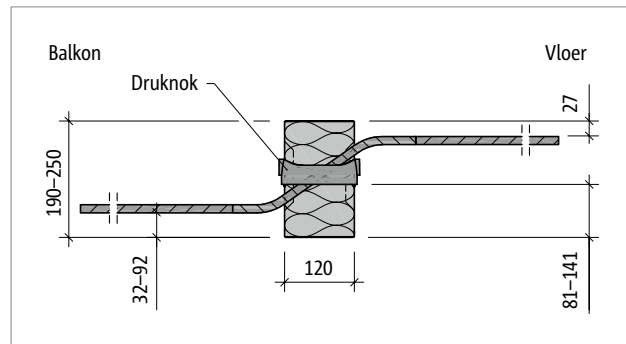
Schöck Isokorf® XT type Q-E-V3 bij : Doorsnede
